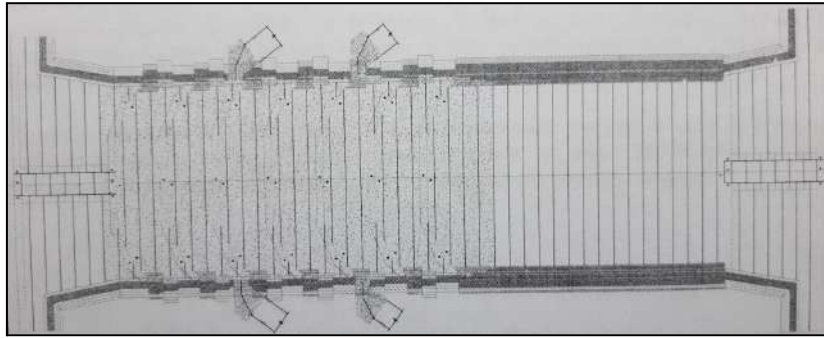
Planta de la obra de control. Arroyo El Gato.
